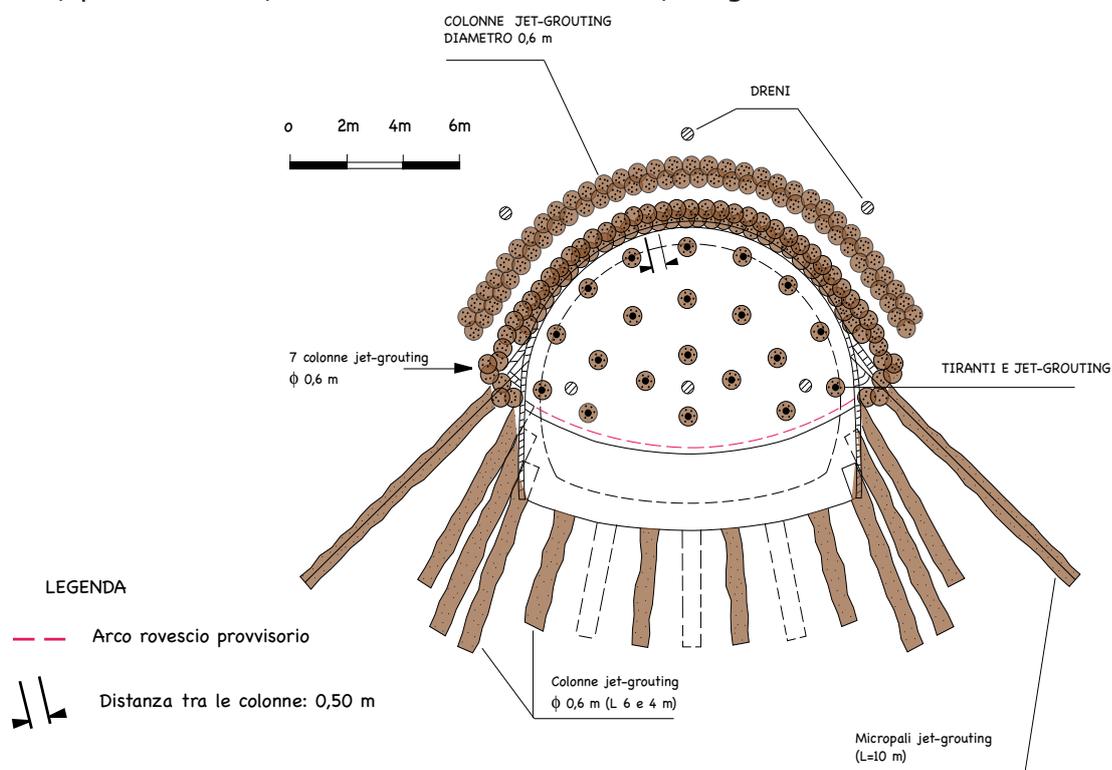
Sezione trasversale della galleria EST, mostrante i particolari d'intervento.
